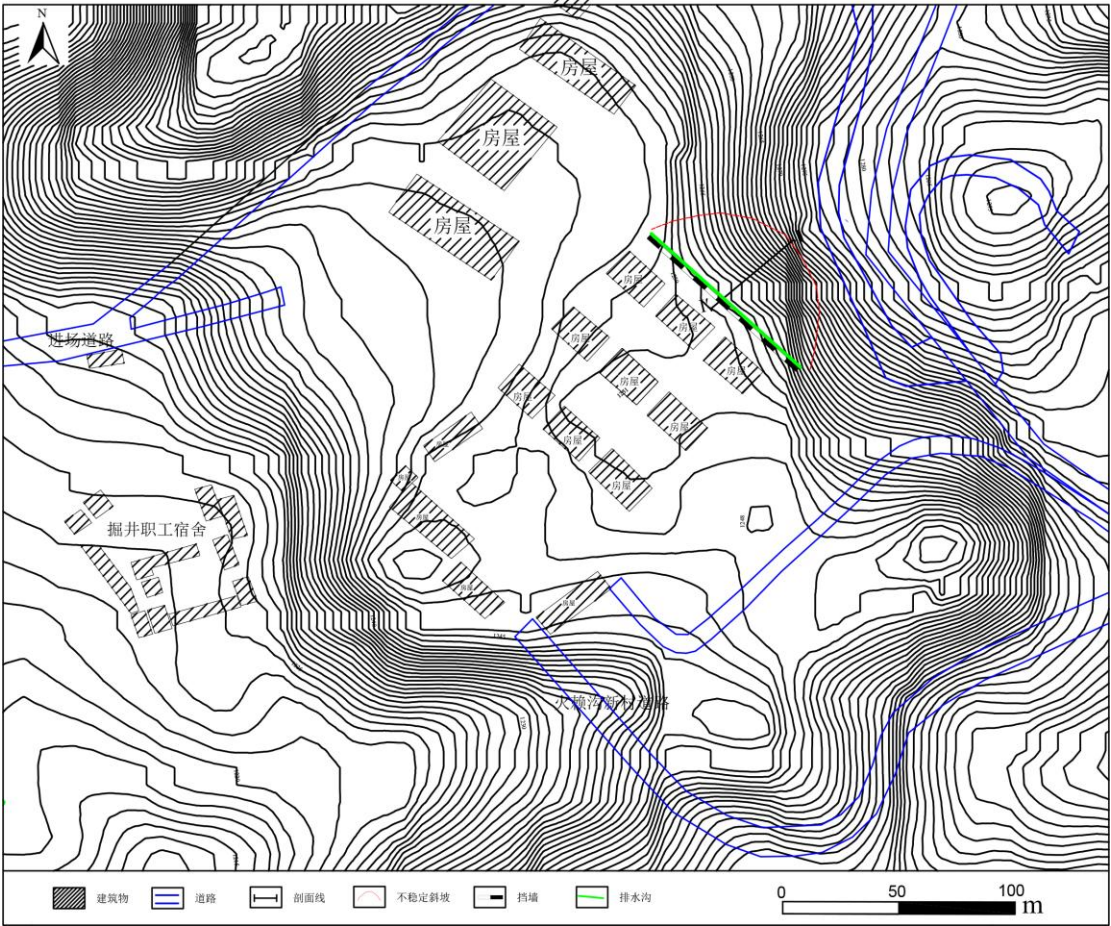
不稳定斜坡 BP2 治理工程平面设计图
